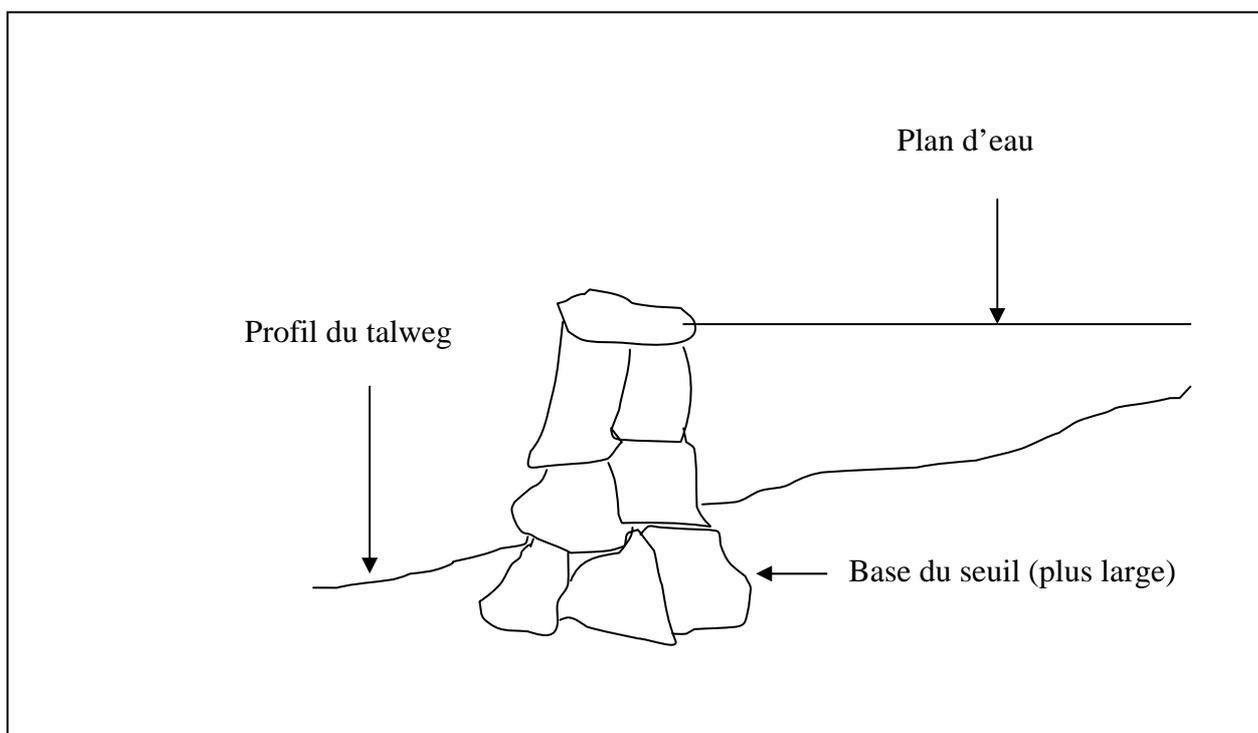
Schéma d'un ouvrage seuil en pierres sèches.
